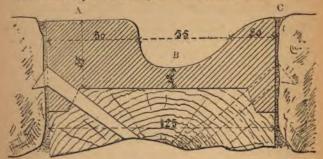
Rail de la 8º Avenue (New-York). Poids : 33 k.
